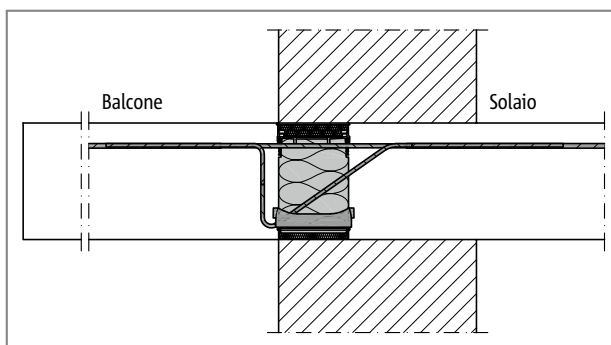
Schöck Isokorb® XT tipo KL: raccordo con appoggio su muratura monostrato
